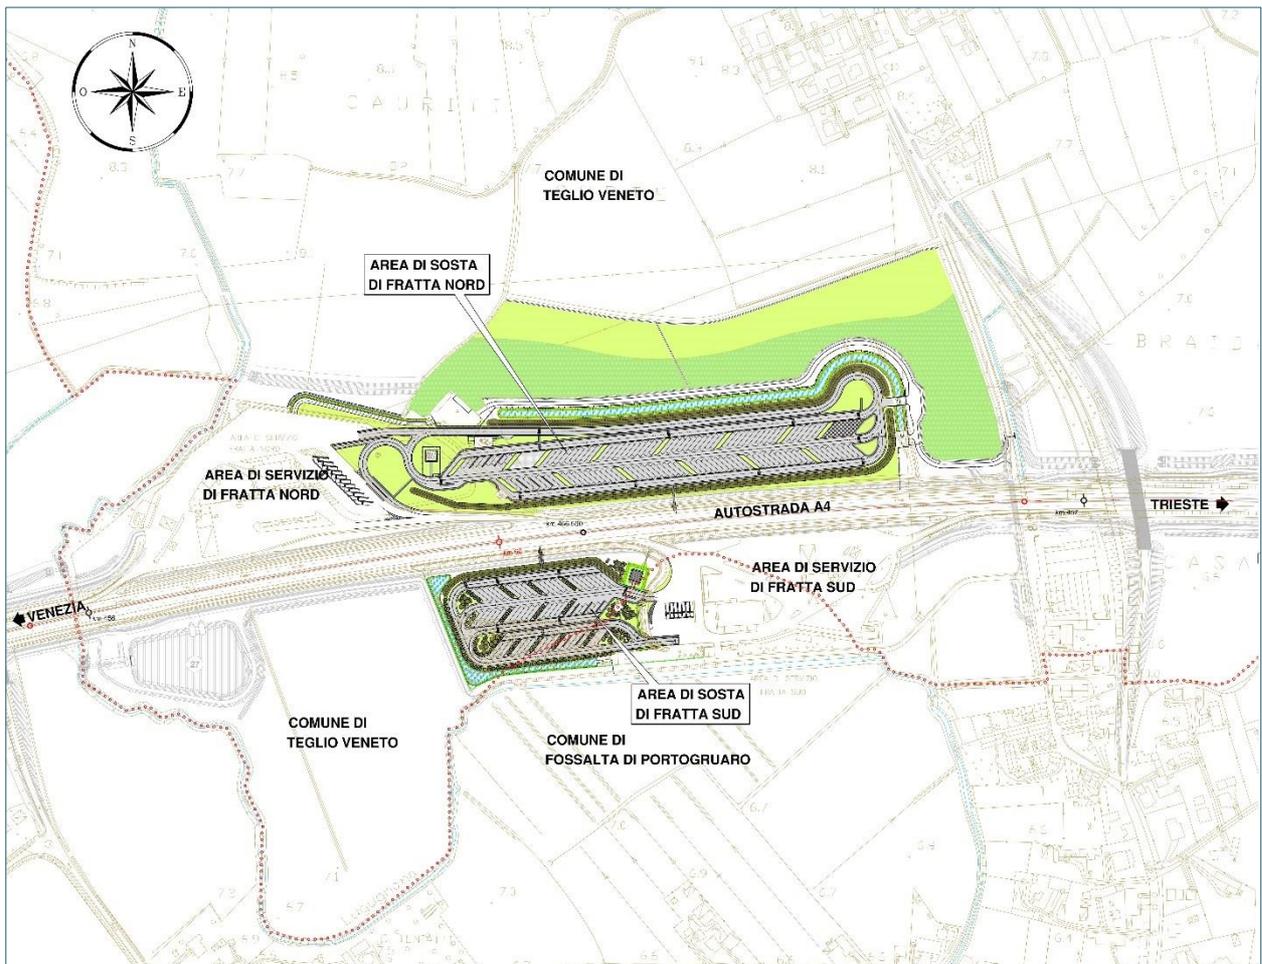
Planimetria di inquadramento (stralcio elab. E.01.00.0.0).
